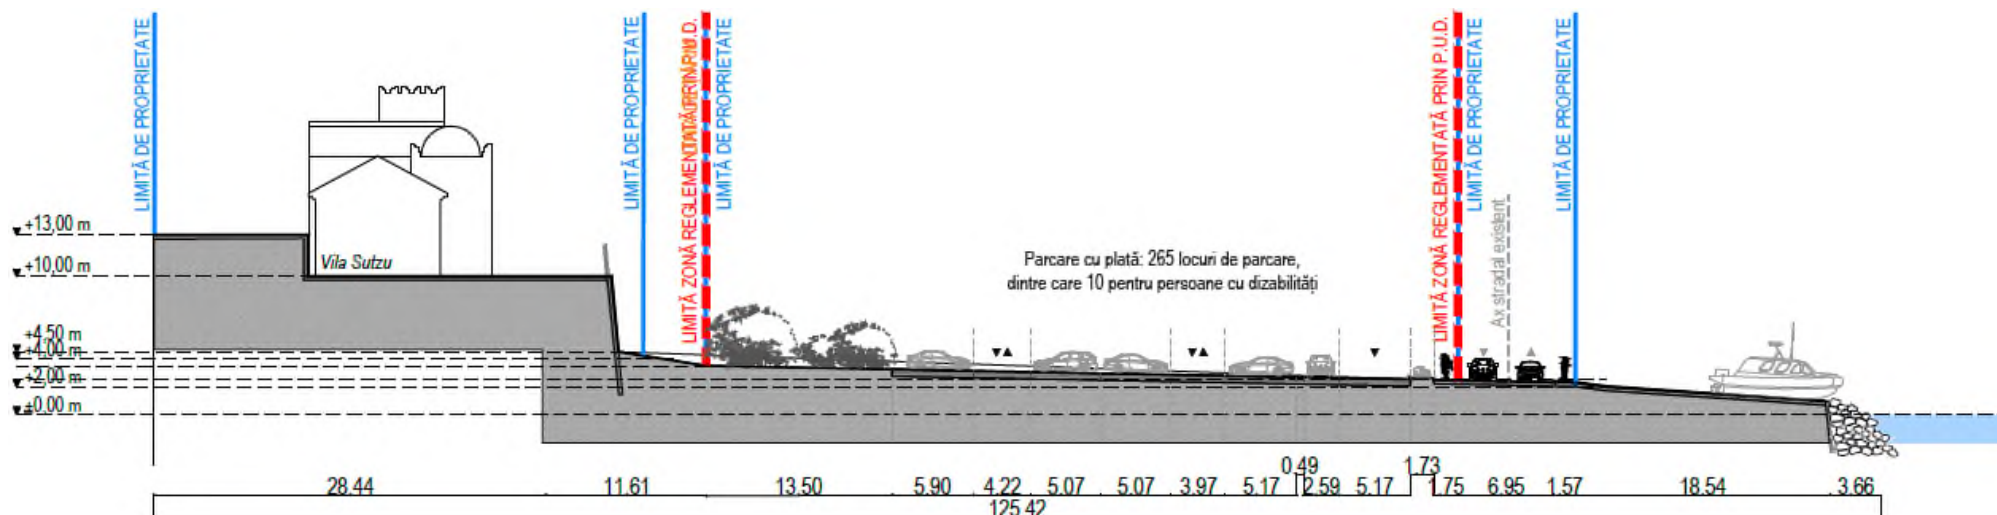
Profil stradal – strada Lebedei + spații adiacente
